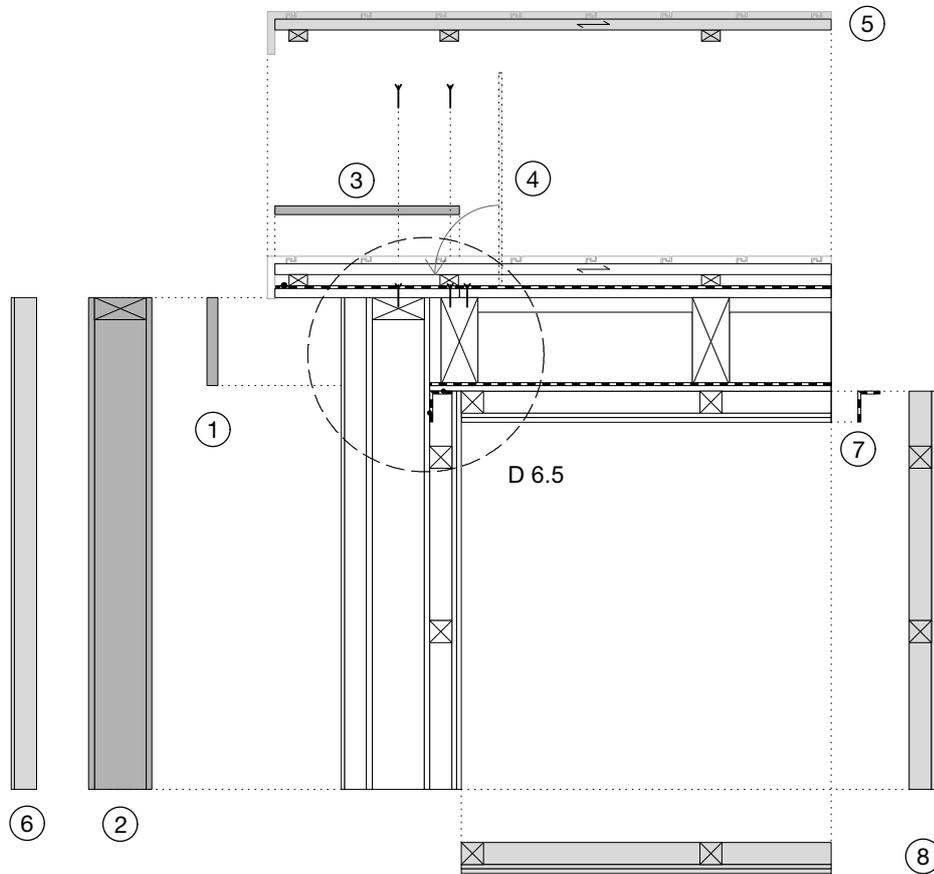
Montagereihenfolge - Anschluss Ortgang Steildach - Außenwand, vorgestellt
